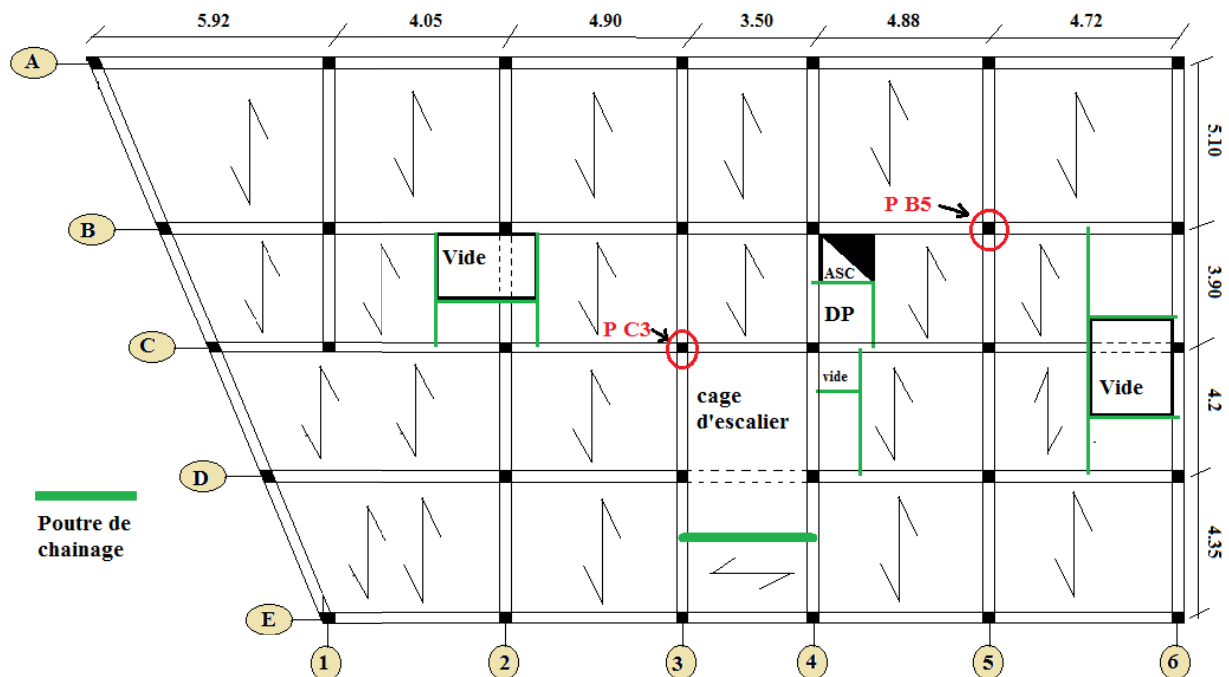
Schémas de la disposition des poutrelles (niv 1-10)
